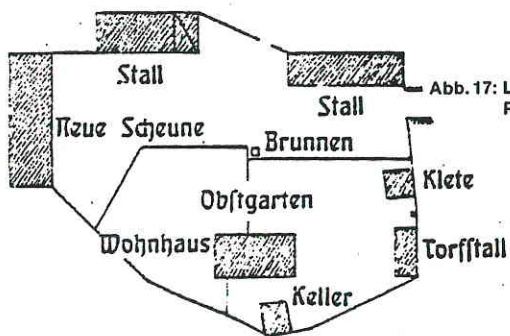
Lageplan des Hofes des Bauern Pawels in Pempen, Kreis Memel, mit Vielhausanlage
